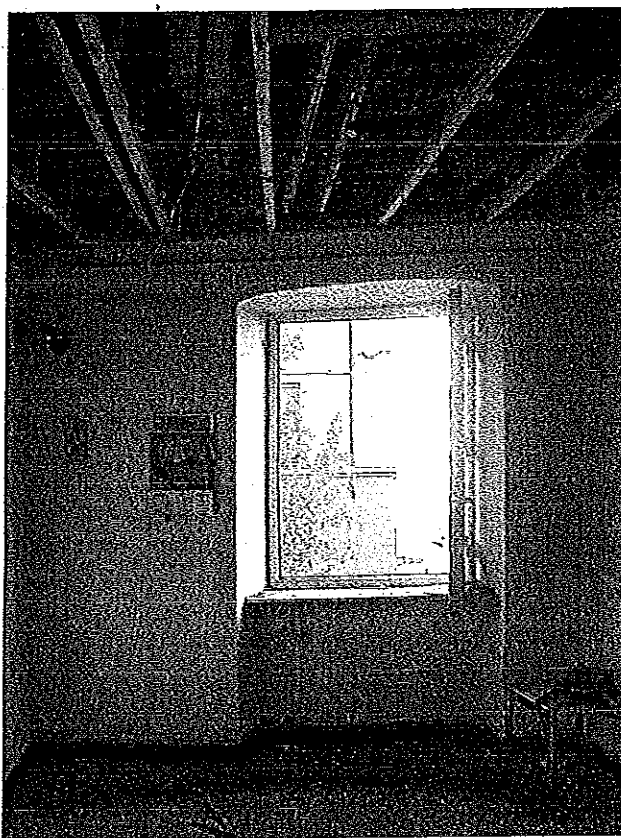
Il locale A col soffitto mancante ed il solaio ligneo in vista.
